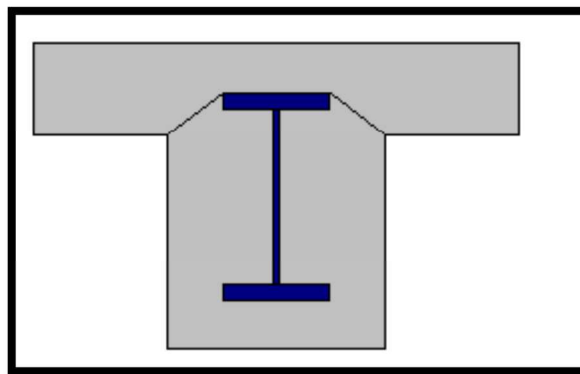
Cortante horizontal entre la losa y la viga
